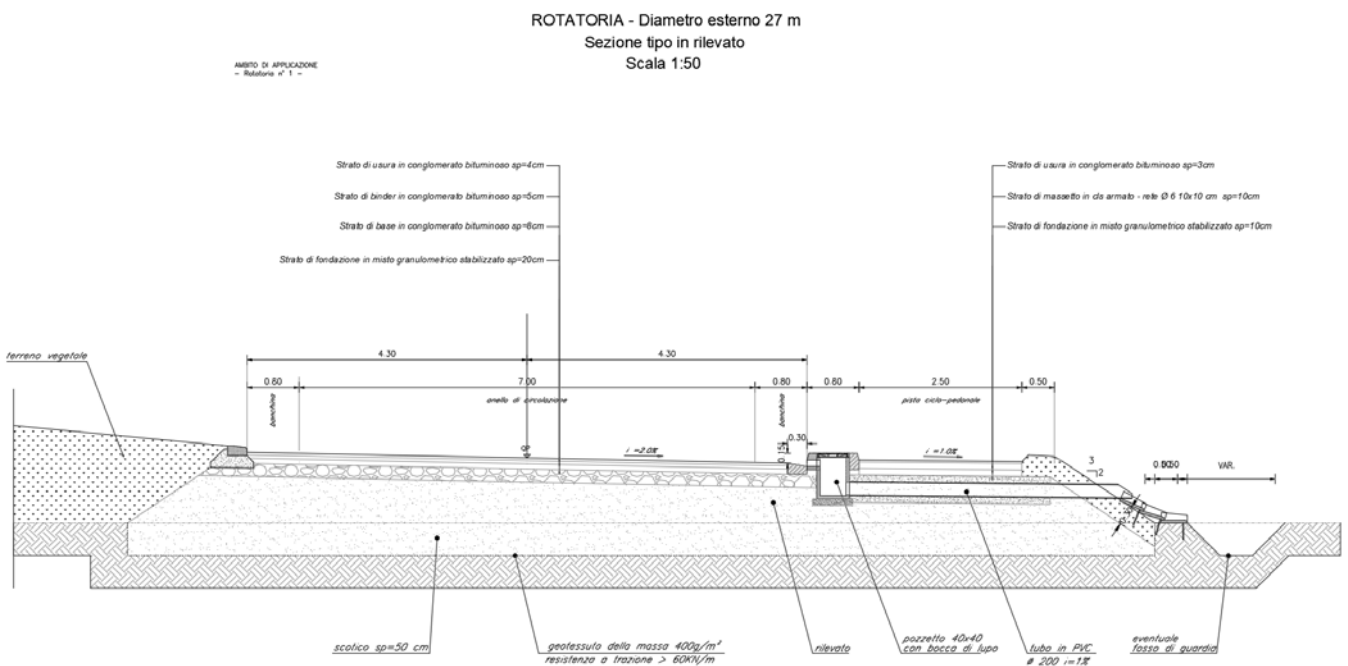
Sezione tipo in rilevato Asse A e B
